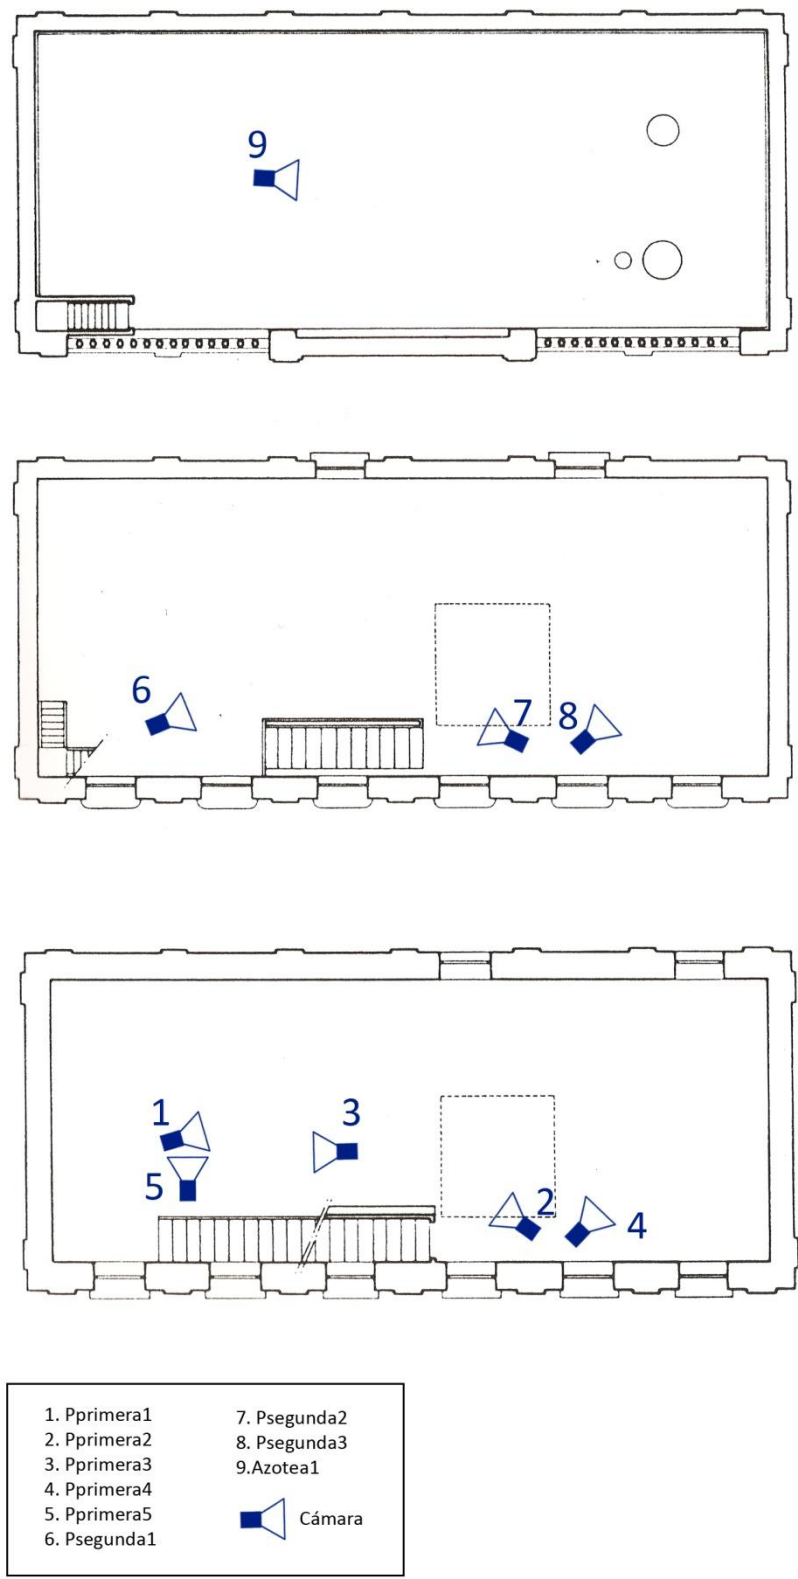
Distribución de las cámaras en la azotea (arriba), planta segunda (centro) y planta primera (abajo).
